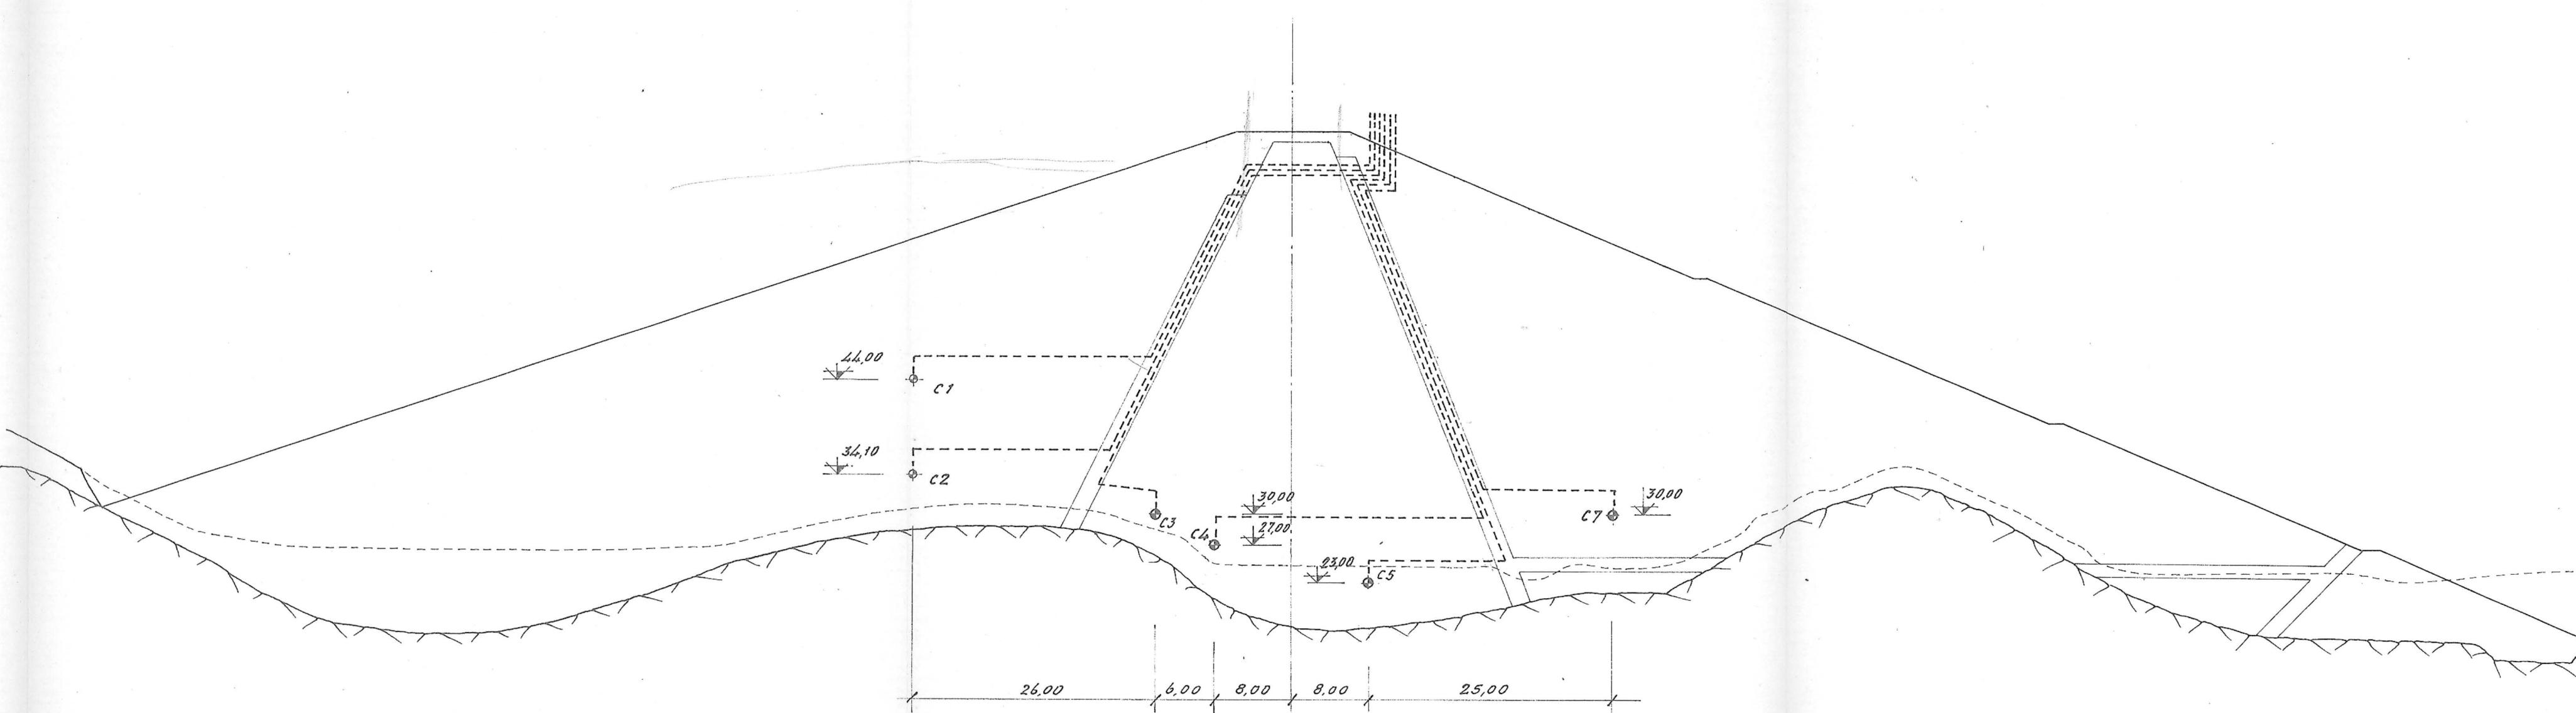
BARRAGEM DE MORGAVEL, PLANTA DE
